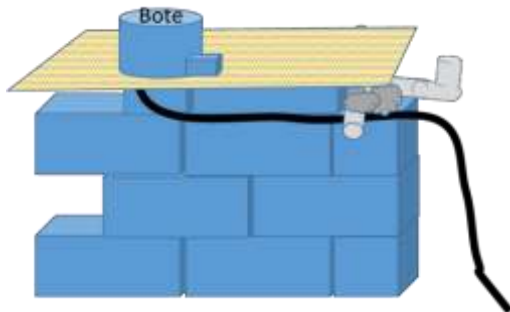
Mangueras de orina y armado de tubería de gases integrados a la losa
